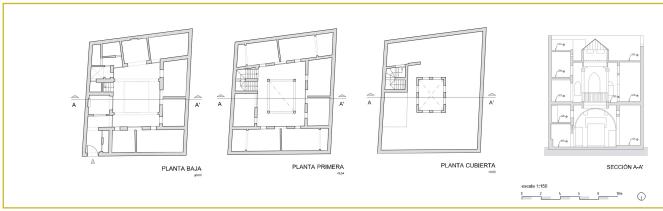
Plantas y corte de dar Hotel Arabic (fuente: Los autores).
